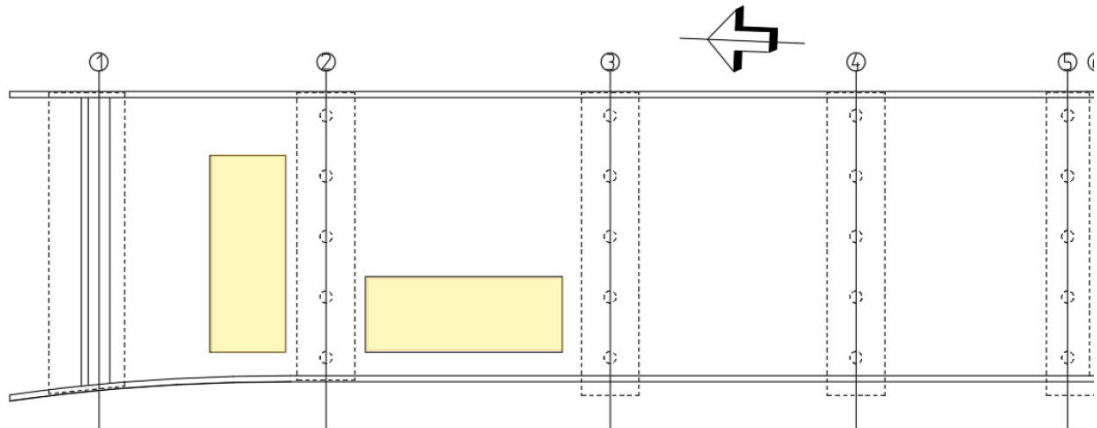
Norra brodäcket genom Kv. Korhoppet- Plan.
